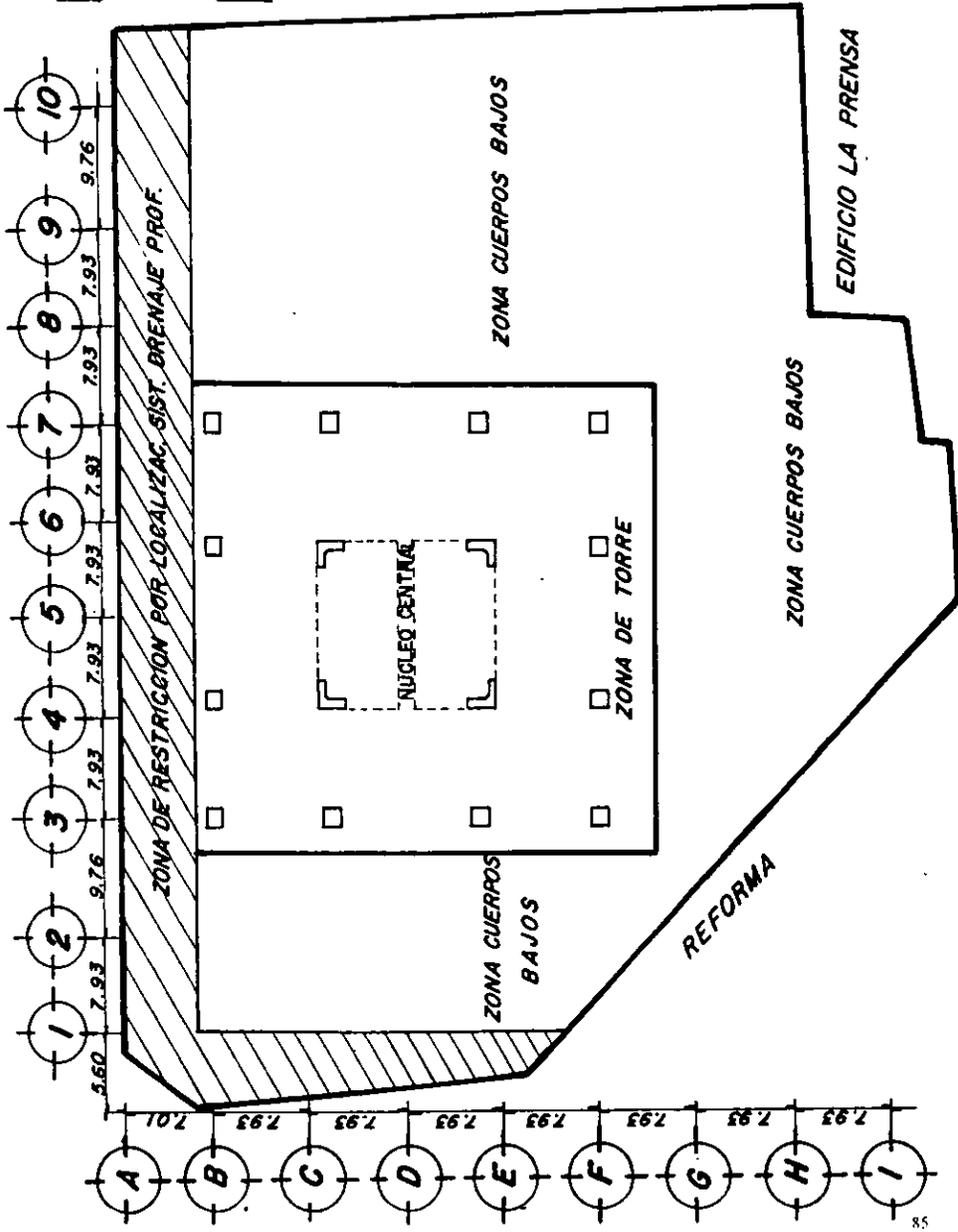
LOCALIZACION DE COLUMNAS EN ZONA DE TORRE
